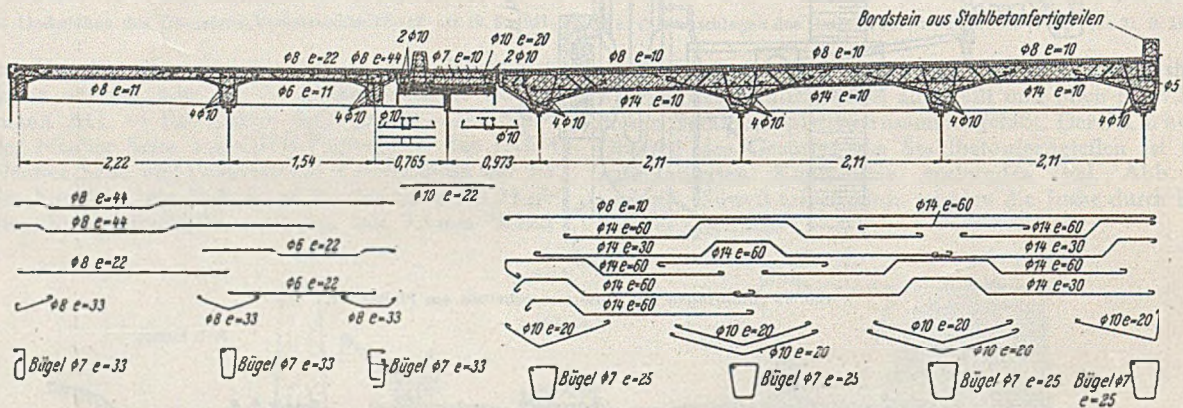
Bewehrung der Fahrbahn- und Gehwegplatten der Flutbrücken.
